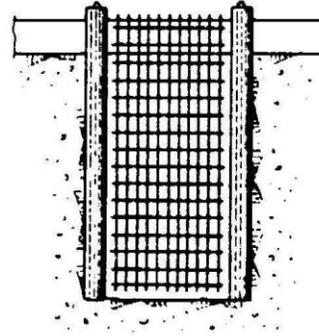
Detalle de la armadura totalmente instalada en el módulo (corte longitudinal).
